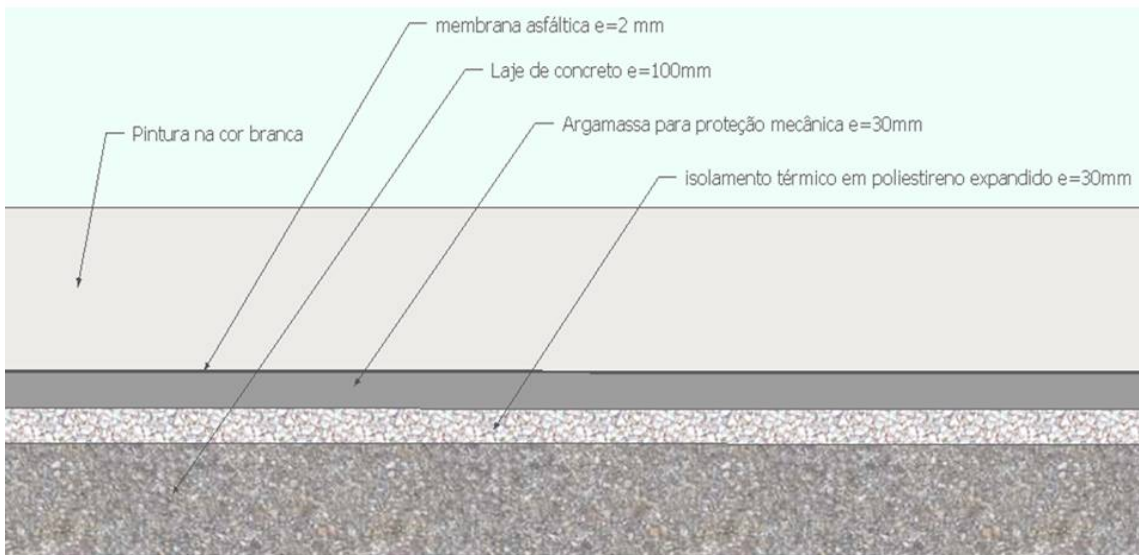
esquema do sistema construtivo utilizado na cobertura.
